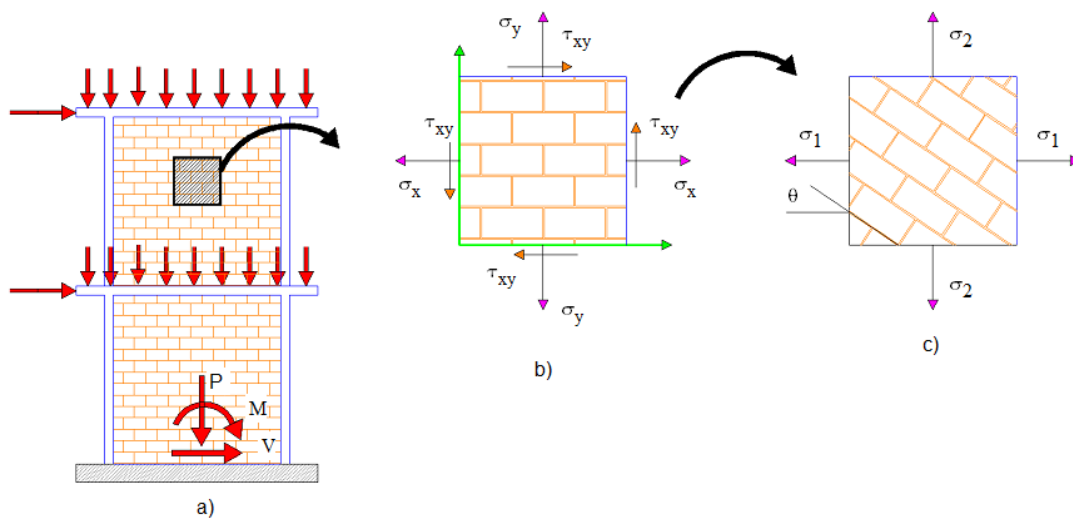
Comportamiento de la mampostería reforzada sujeta a fuerzas combinadas: a) muro típico de mampostería confinada y reforzada interiormente sujeta a fuerzas axiales y laterales; b) panel representativo c) esfuerzos principales en el panel
